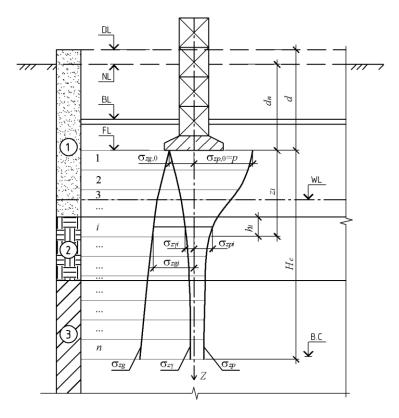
Схема для расчета осадки методом послойного суммирования
